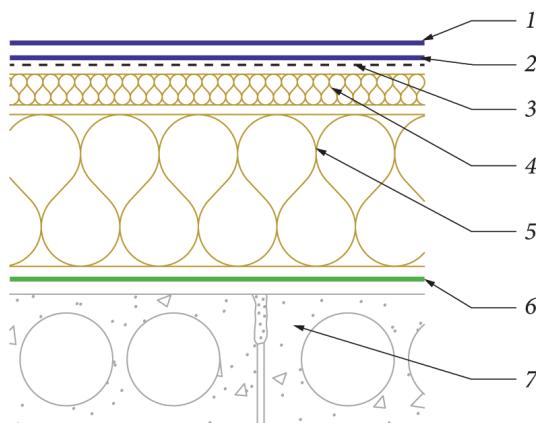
Кровельный пирог по основанию из минераловатной плиты:
